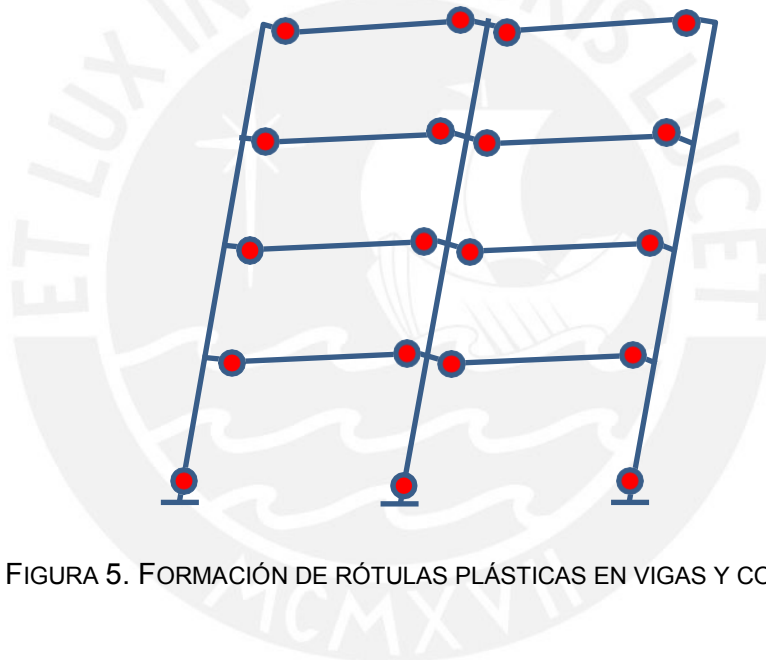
FORMACIÓN DE RÓTULAS PLÁSTICAS EN VIGAS Y COLUMNAS
